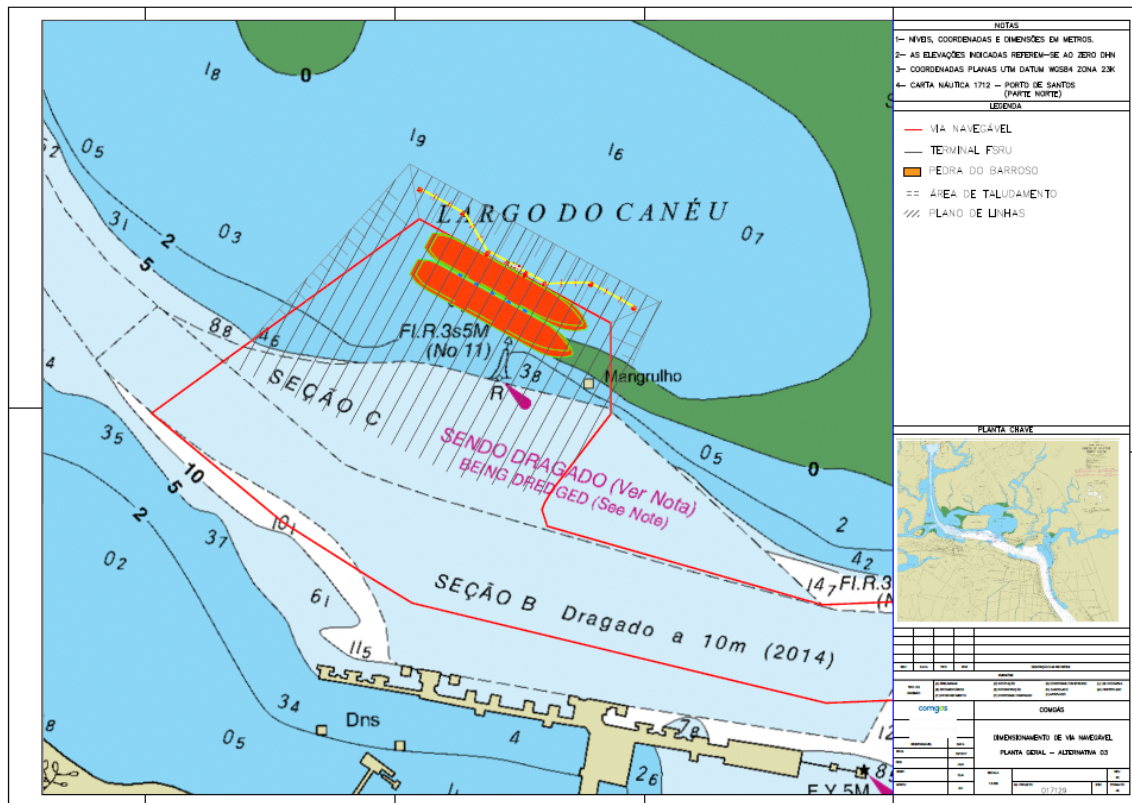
Plano de linhas para execução da dragagem.
